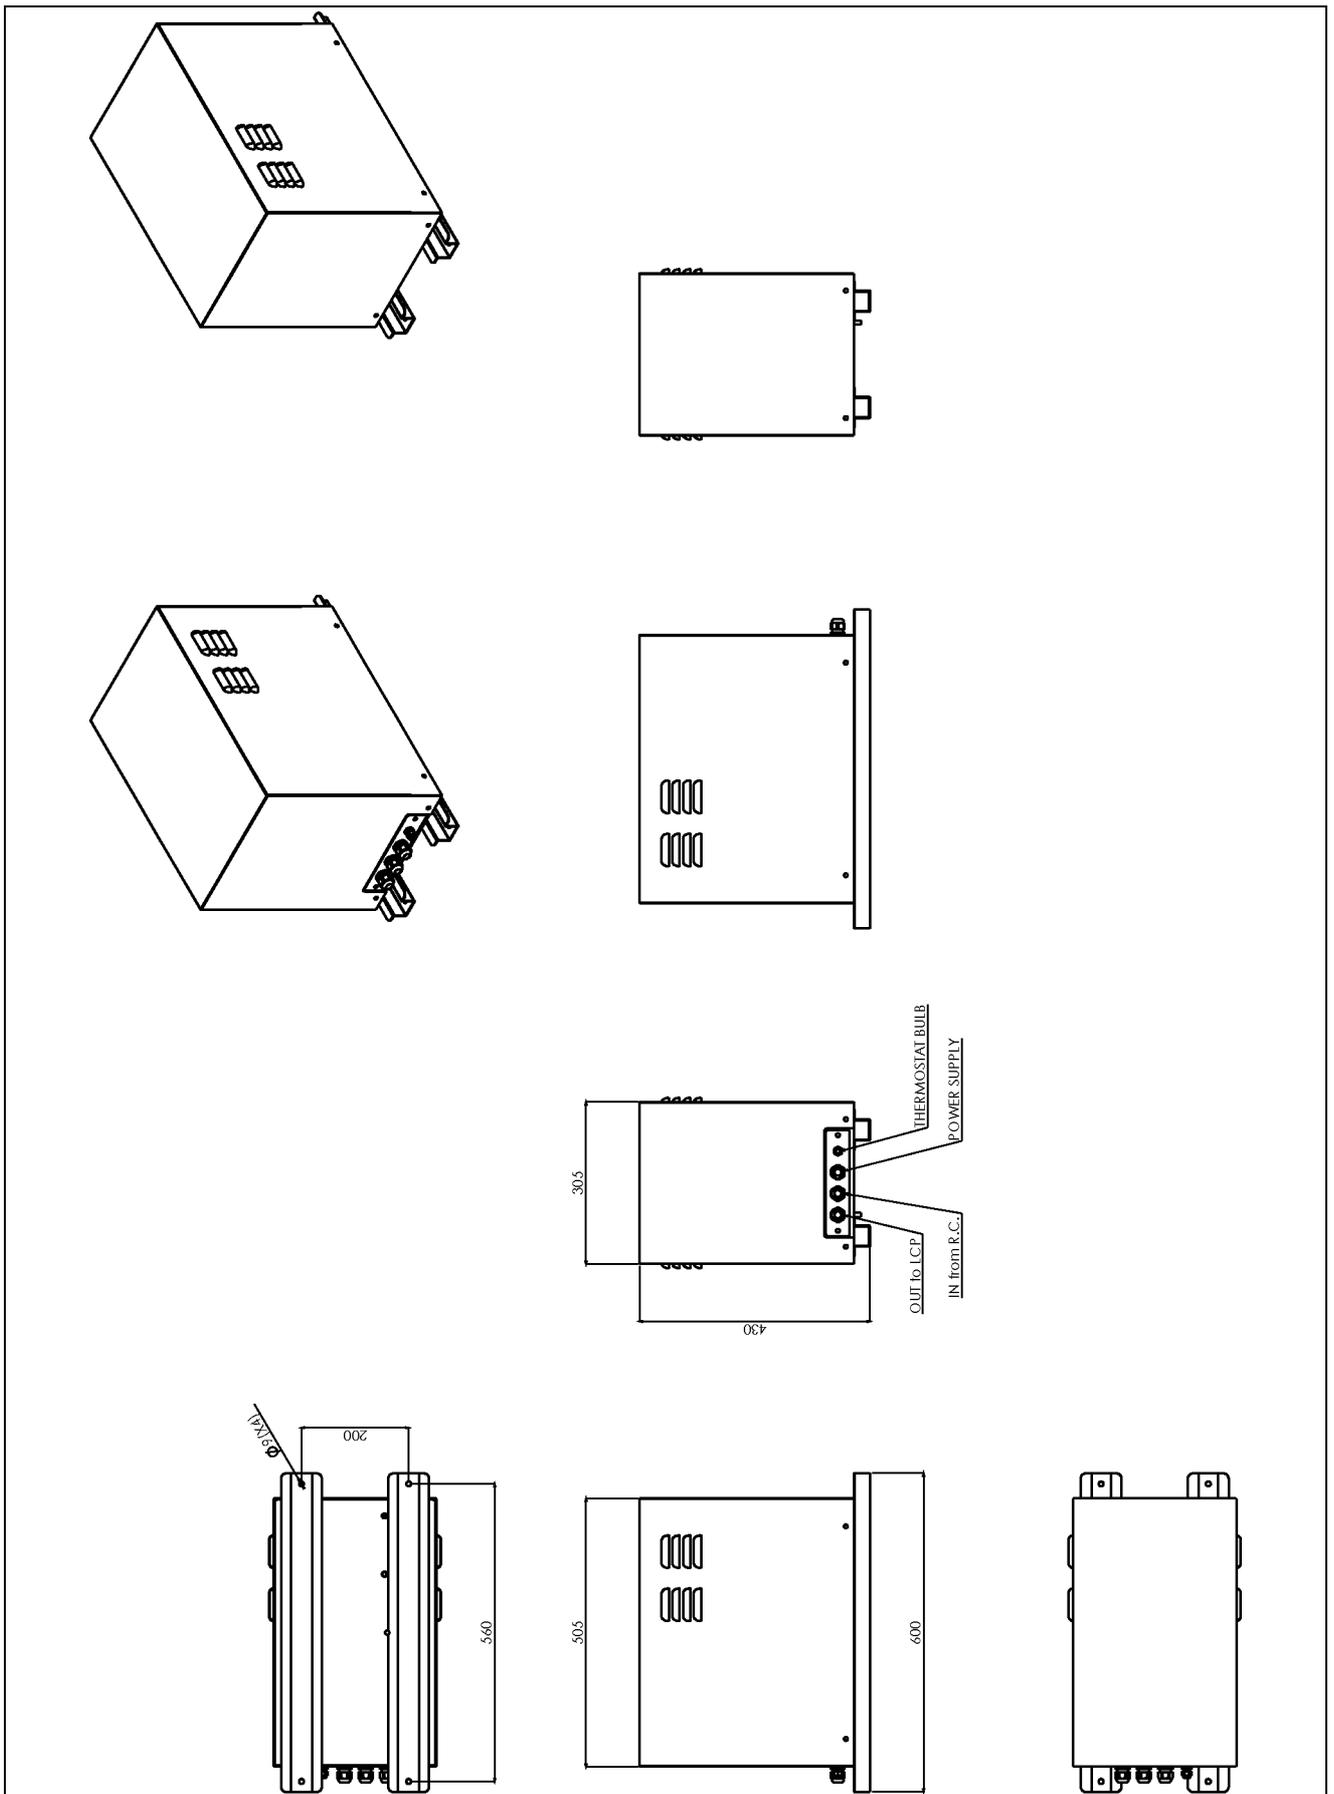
plan d'installation du boîtier hydraulique (unité basse température)
